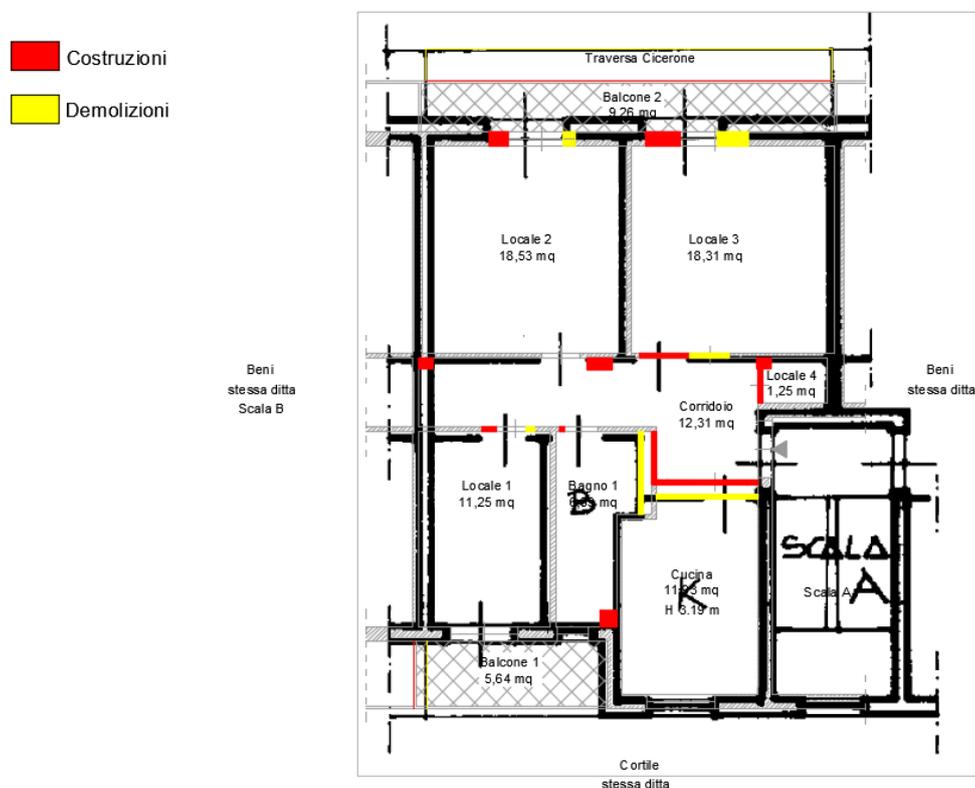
Confronto con planimetria catastale (Foglio 4, p.lla 1225, sub. 3)
